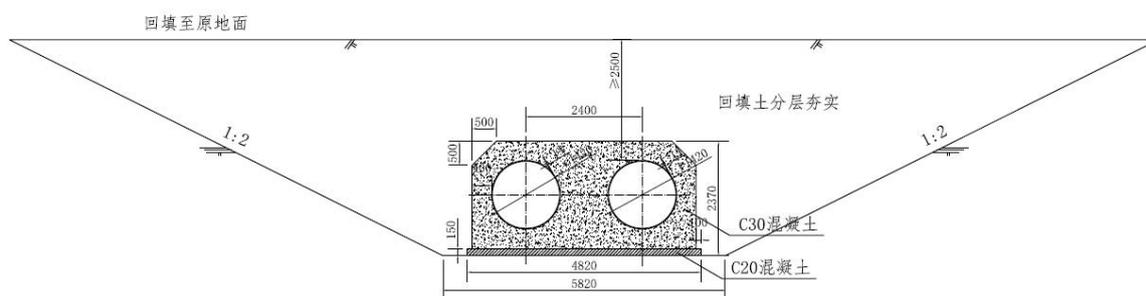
供水管道穿越岔河横断面图
